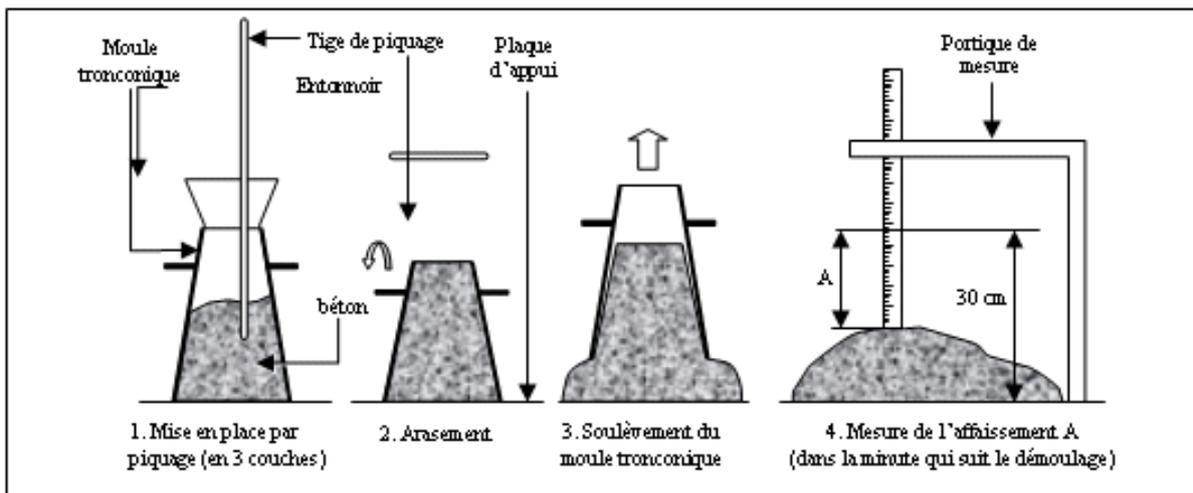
schéma explicatif de l'essai d'affaissement.
